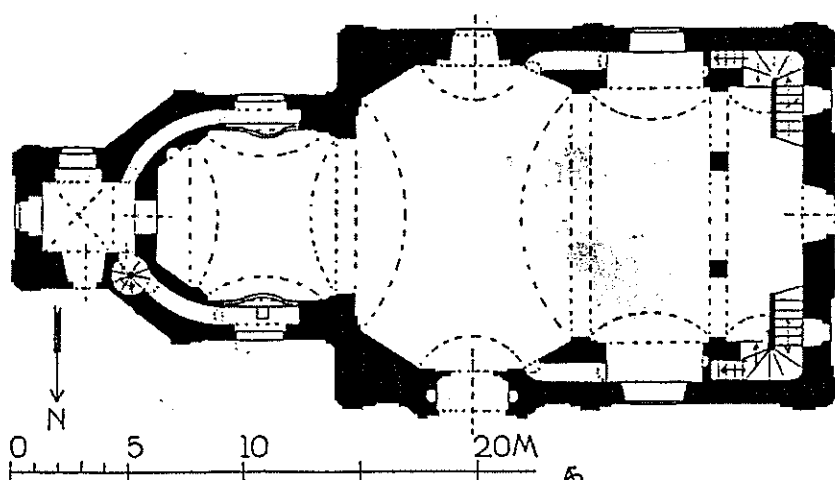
Habakladrau. Grundriß der Pfarrkirche.
